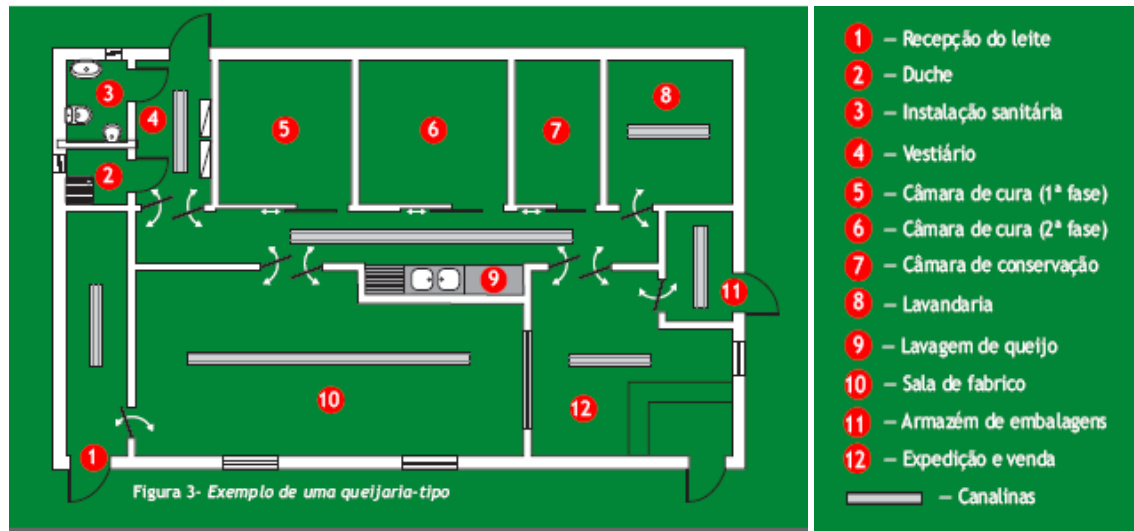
Planta baixa de queijaria-tipo para queijo tipo curado (NORONHA, 2005b).
